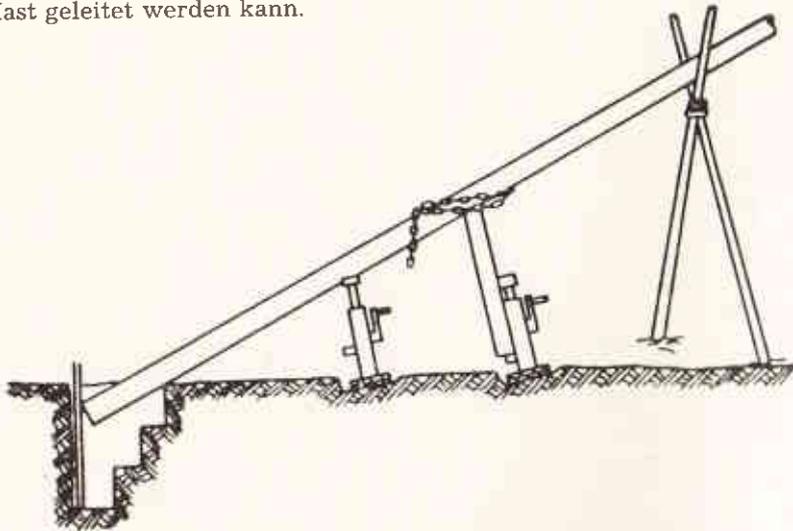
Aufrichten eines Mastes mit Windeböcken
